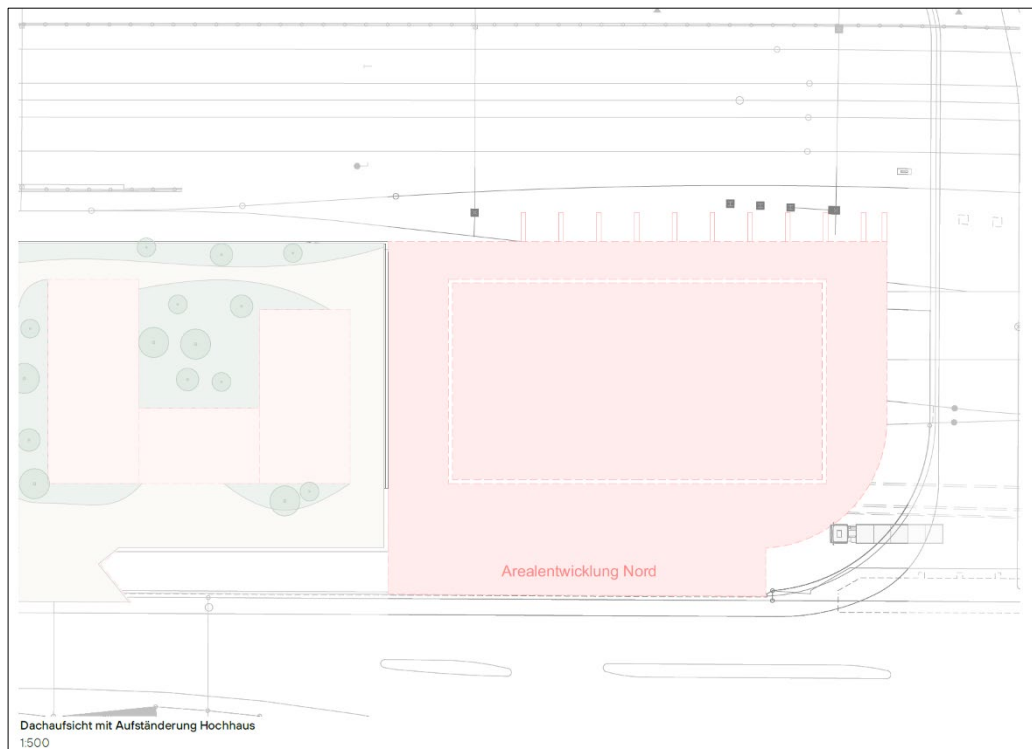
Dachaufsicht mit Aufständerung des Hochhauses
